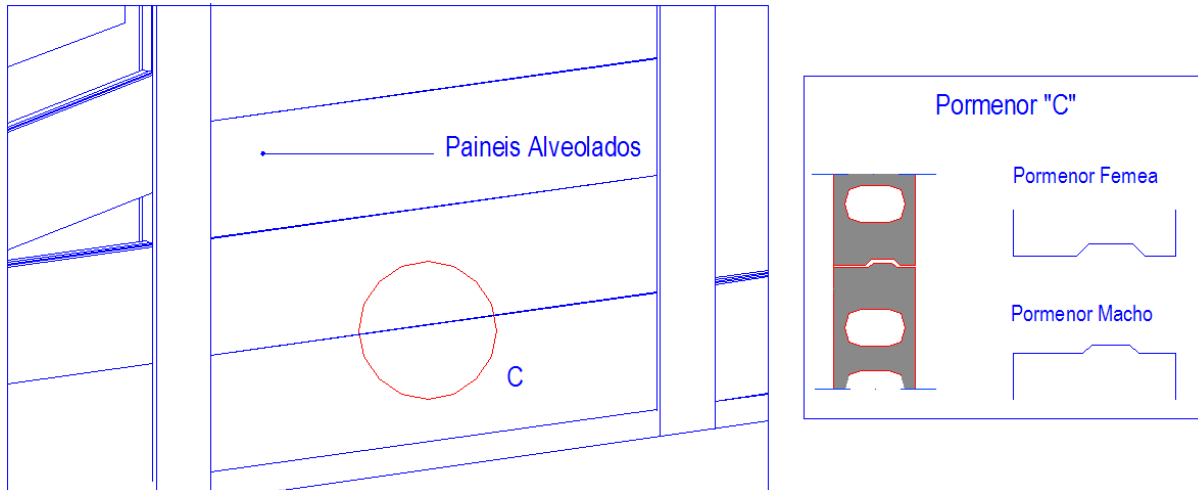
Pormenor de ligação macho – fêmea entre painéis pré-fabricadas
